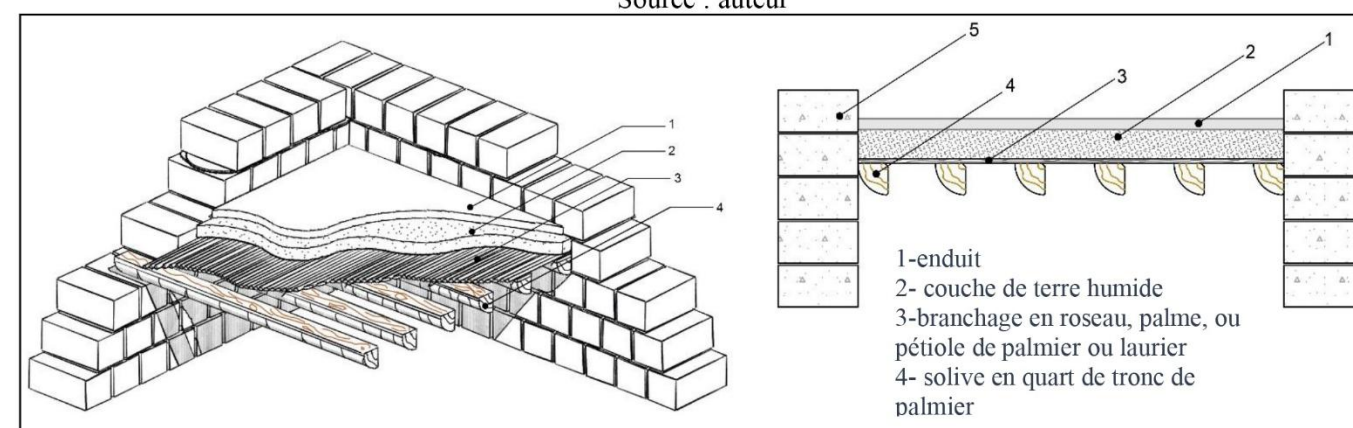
Axonométrie et coupe verticale d'un plancher traditionnel placé directement sur le mur, constitué de solive de 1/4 tronc de palmier
